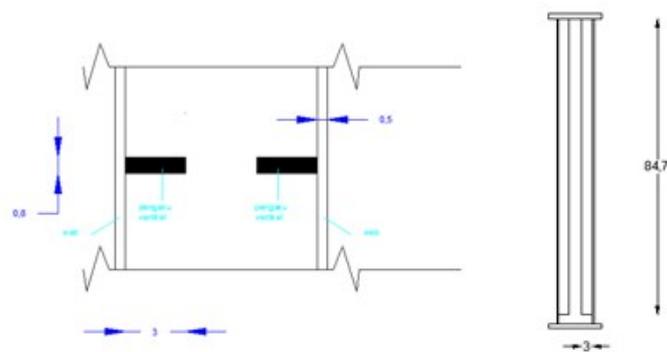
Pengaku Transversal pada Balok Vertikal.
